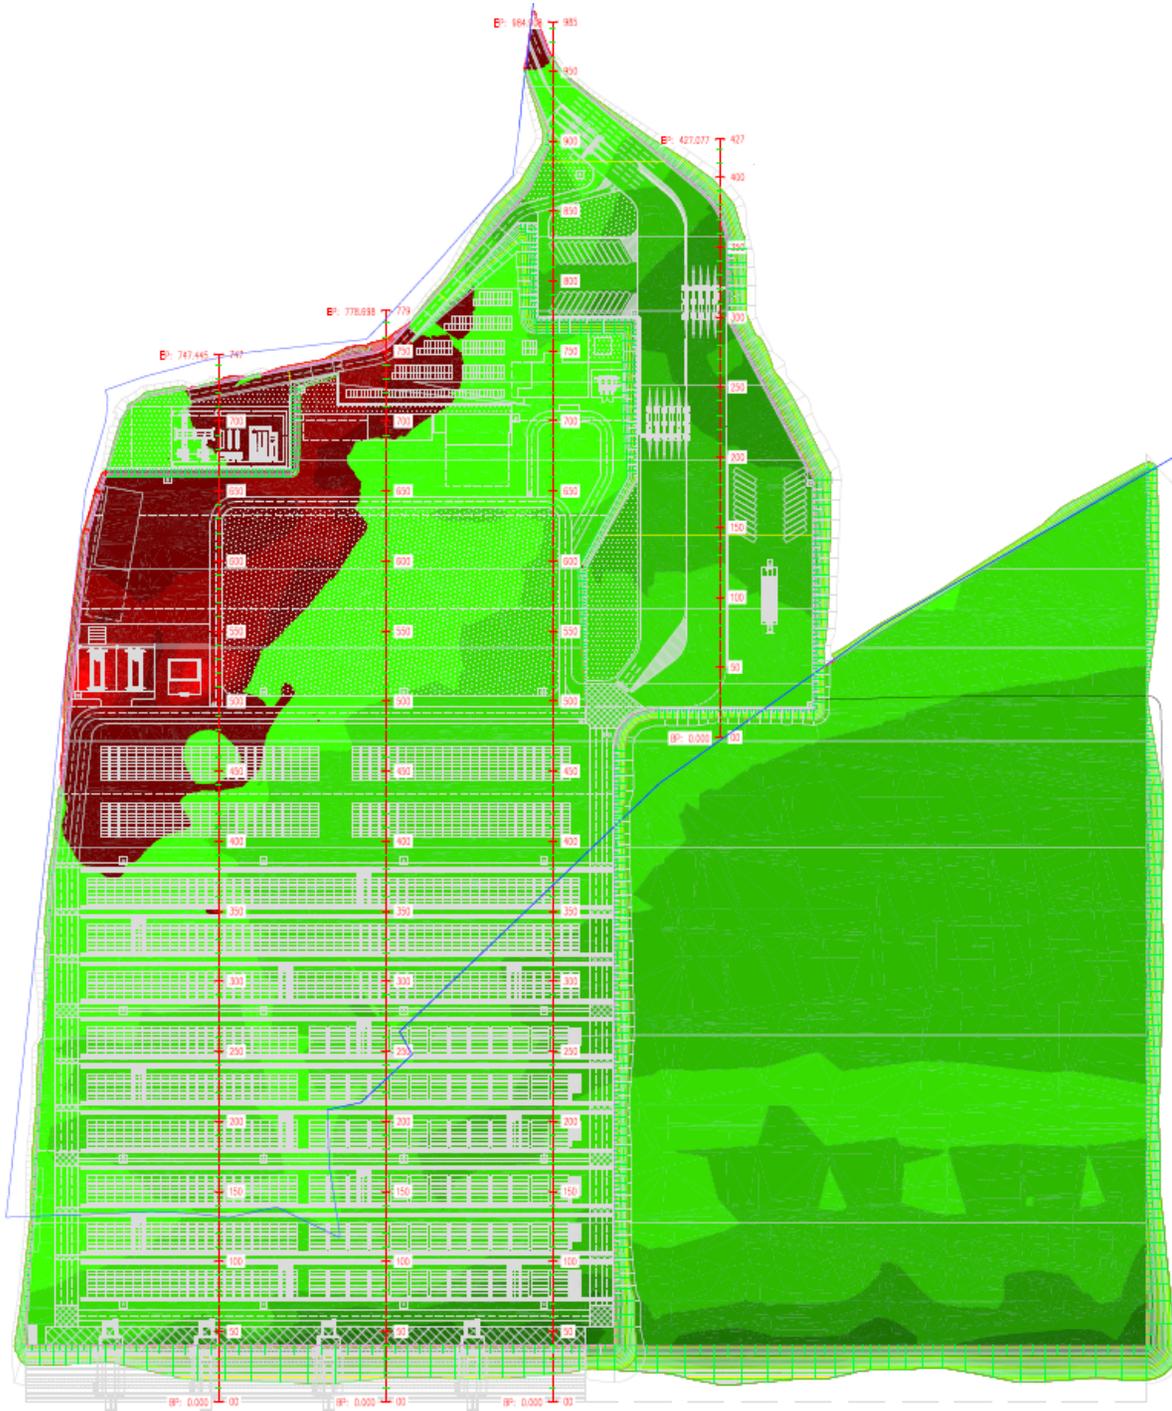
Áreas de corte (color rojo) y relleno (color verde) con la implantación del proyecto
